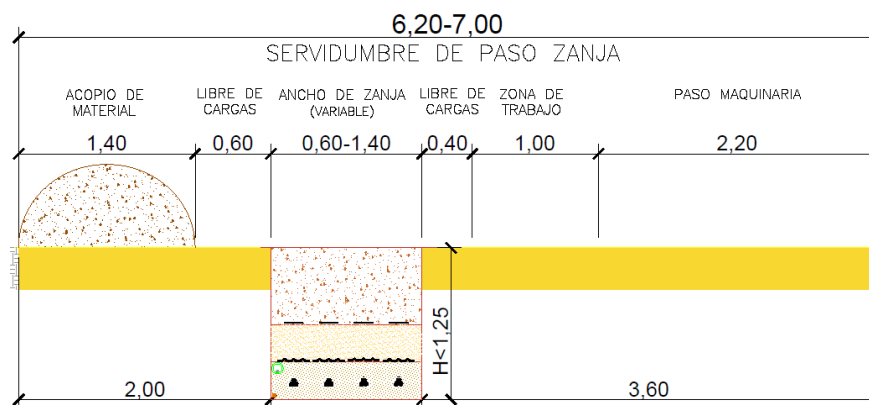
Sección transversal de detalle de servidumbre de zanja
